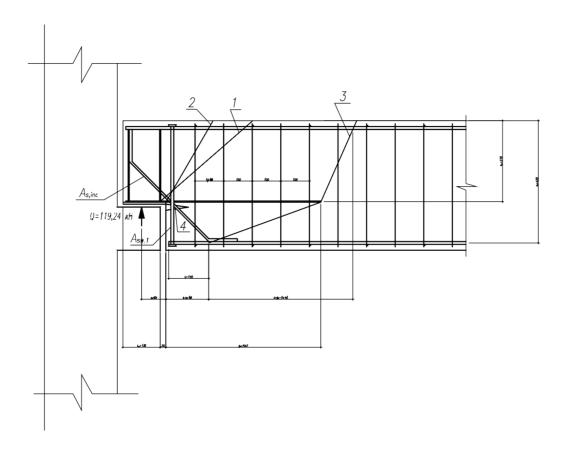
Наклонные сечения на приопорном участке ригеля с подрезкой: 1— при расчете по поперечной силе; 2— при расчете по изгибающему моменту; 3— то же, по изгибающему моменту вне подрезки; 4— горизонтальная трещина отрыва у бходящего угла подрезки.
